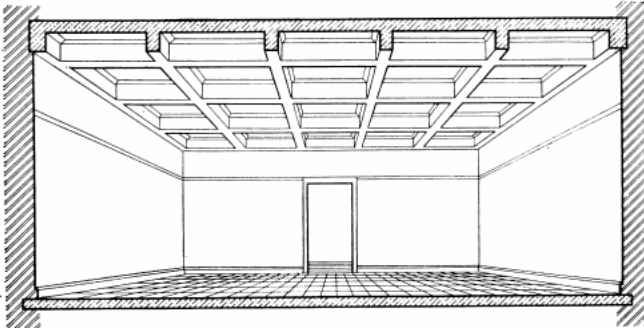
Загальний вид залізобетонного монолітного кесонного перекриття
